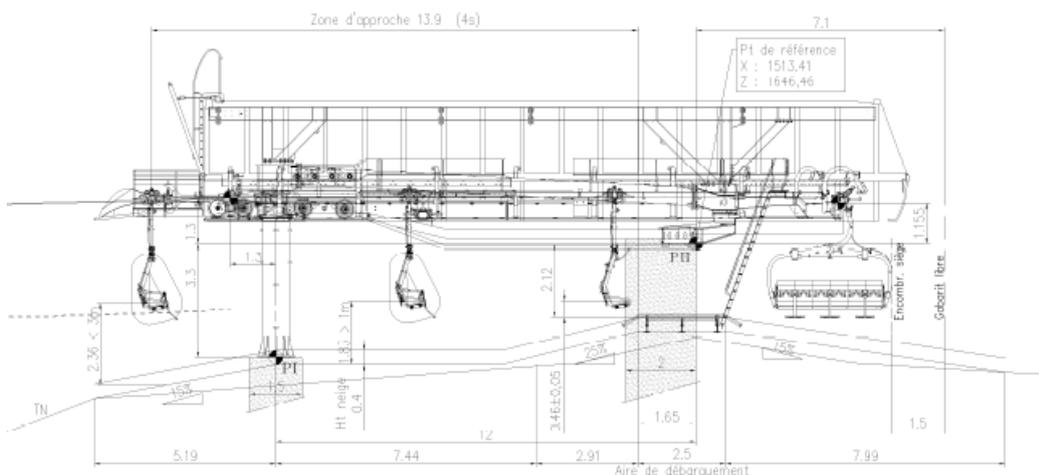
Plan technique de la gare de renvoi (POMA, 2018).
